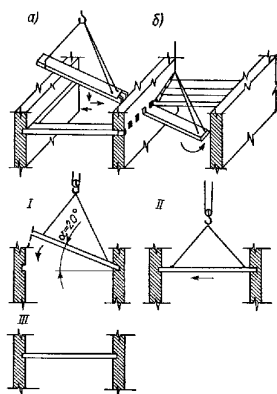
Схемы монтажа железобетонных настилов с выпускными ребрами
